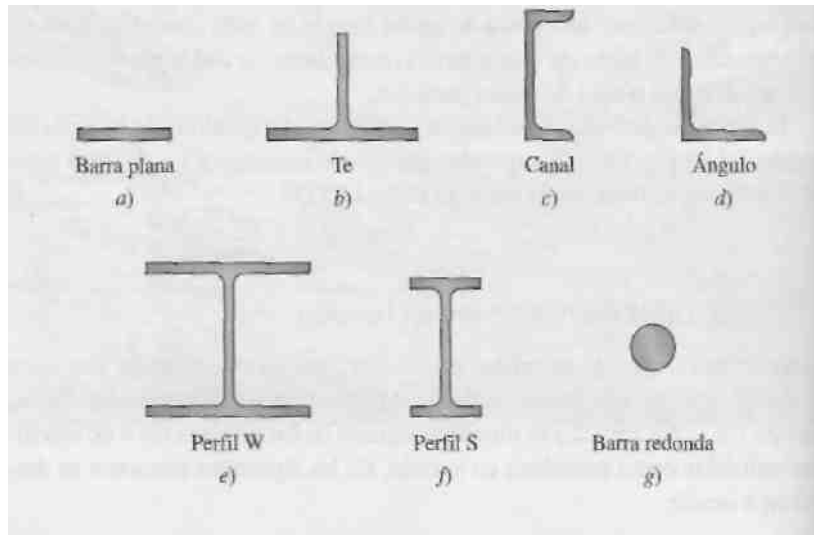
Formas de perfiles simples para elementos a tensión.
